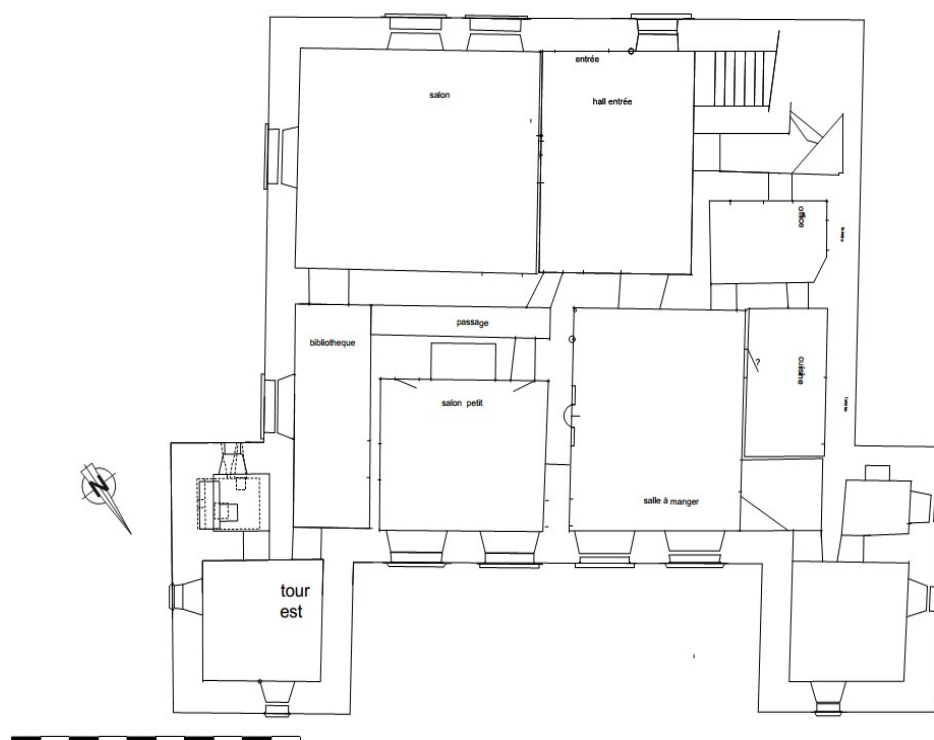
Plan du rez-de-chaussée du château de Mazoncle.
